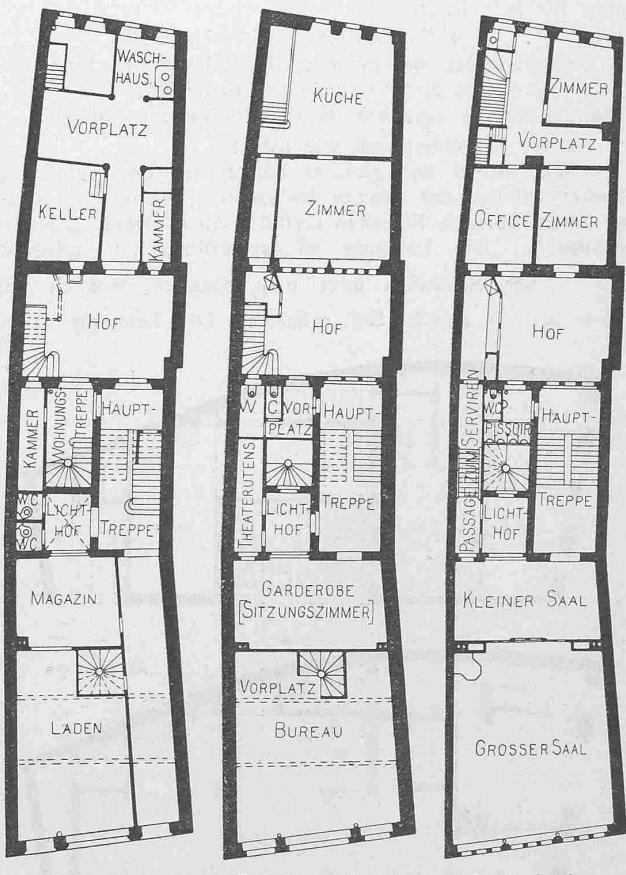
«Zunft zu Hausgenossen». — Grundrisse. — 1:400.
